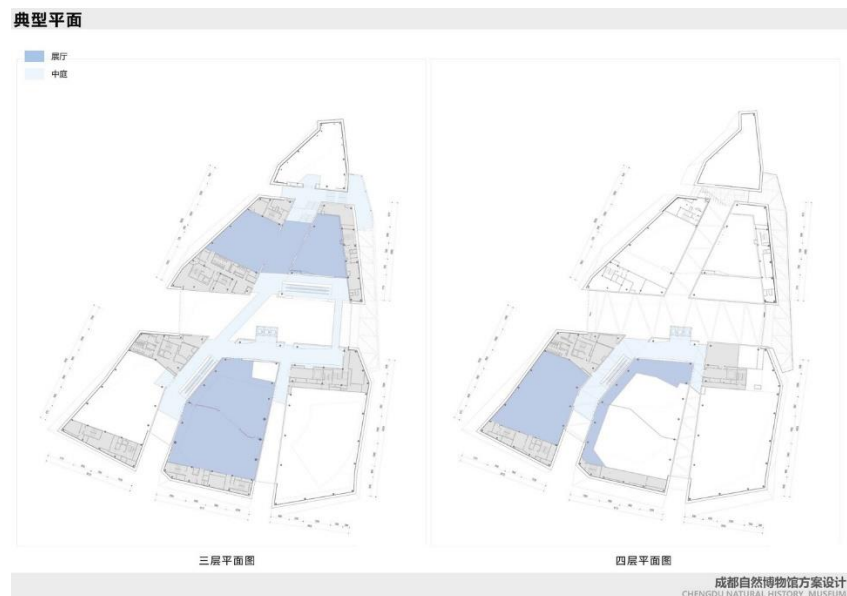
План третього і четвертого поверху будівлі [13]
